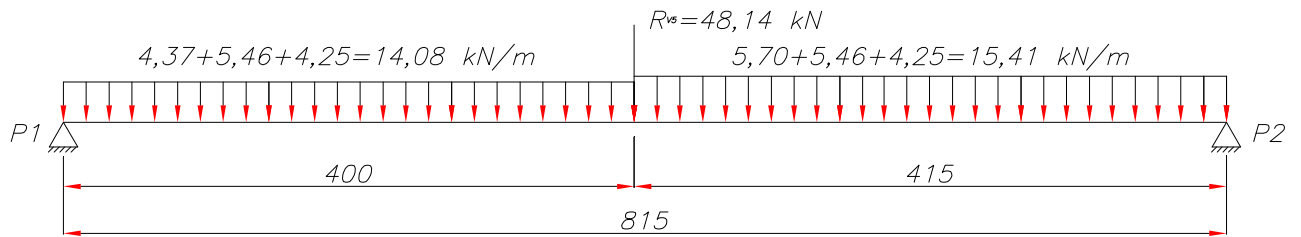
Modelo Estrutural e Carregamento Viga V1
